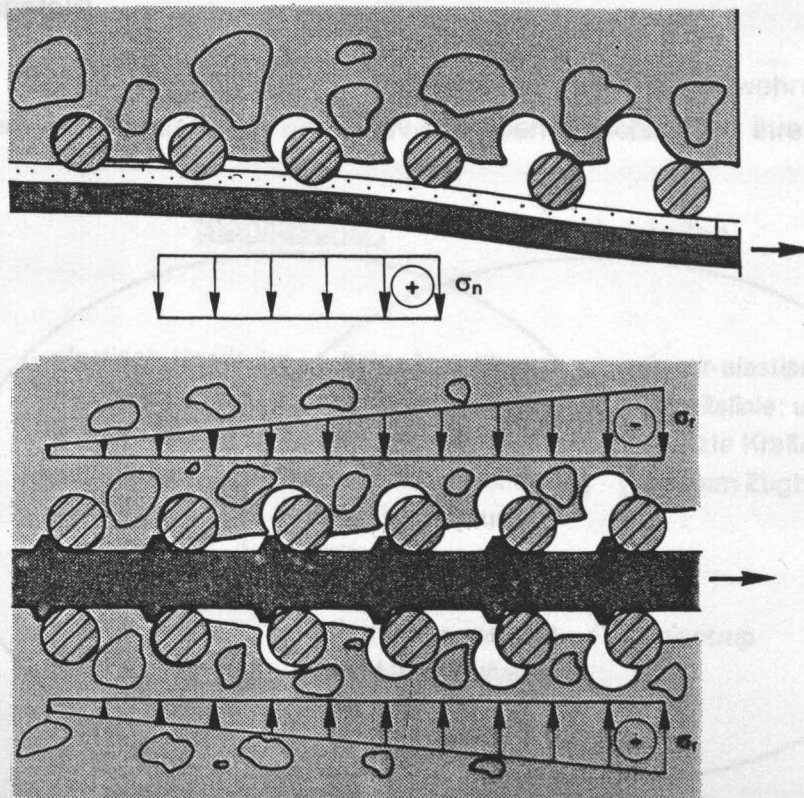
Vergleich von Lamellenverbund und Verbund einbetonierten Betonstahls ohne Sprengbruchgefahr
